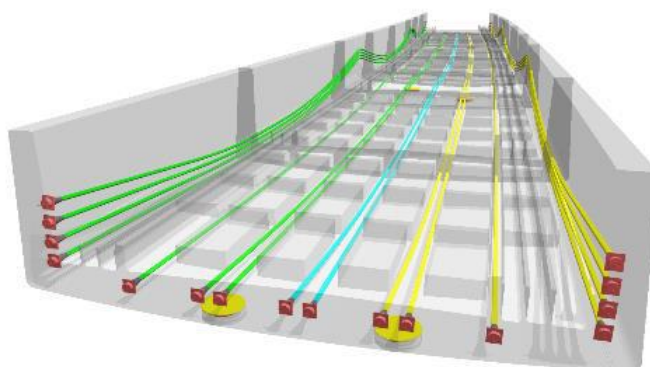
3D модель железнодорожного ж/б моста с армированием напряженной арматурой
